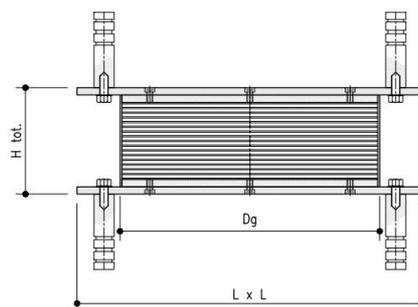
Dispositivo elastomerico ad elevata dissipazione
